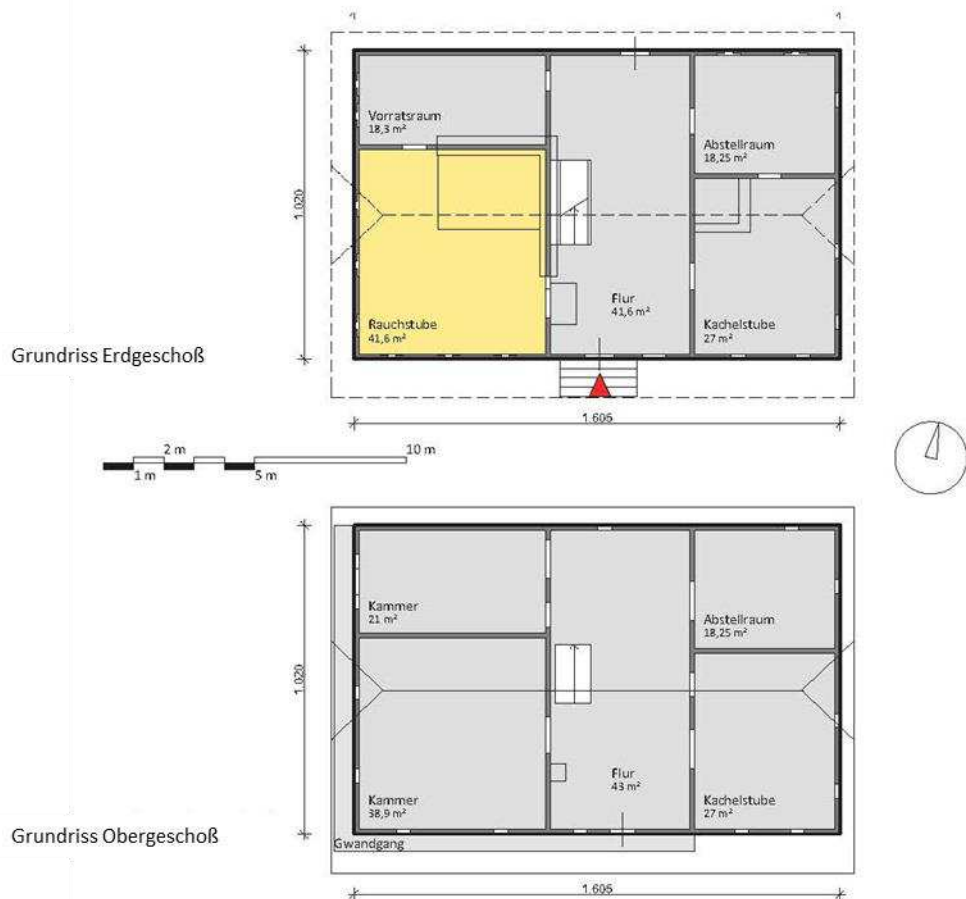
Grundrissdarstellung von Erd- und Obergeschoß des Wohnbereiches
